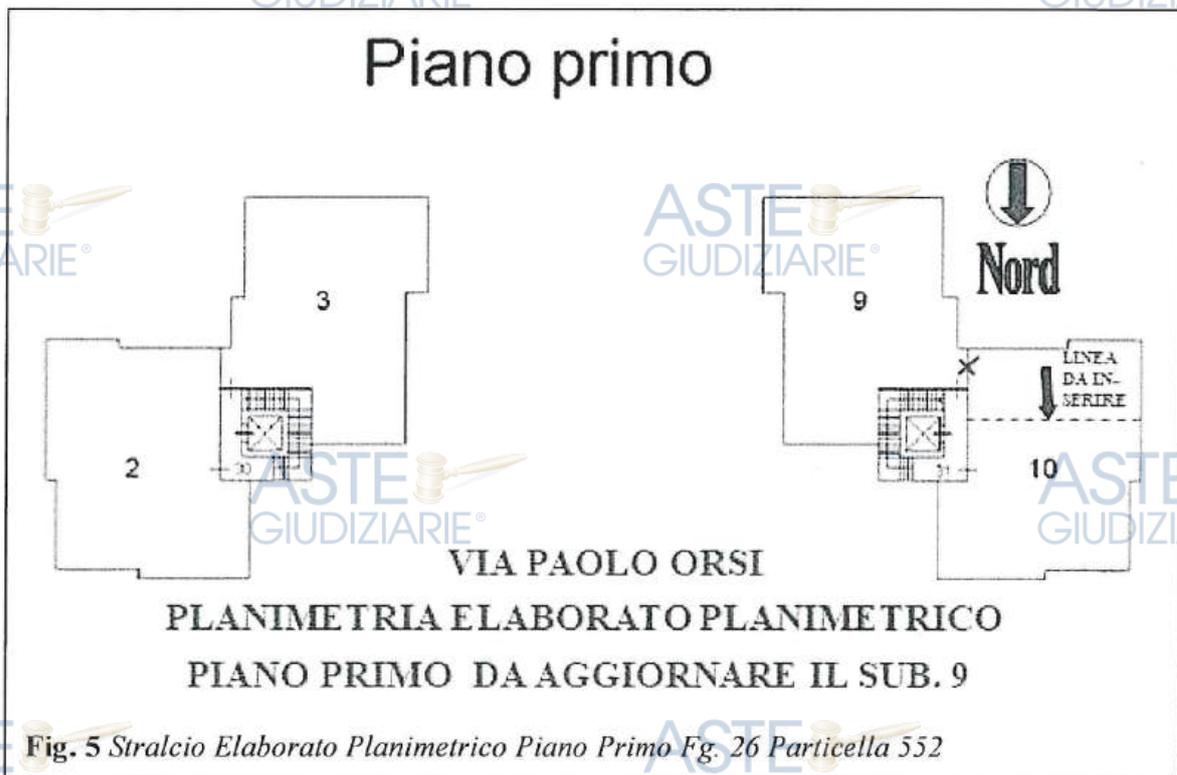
Stralcio Elaborato Planimetrico Piano Primo Fig. 26 Particella 552
